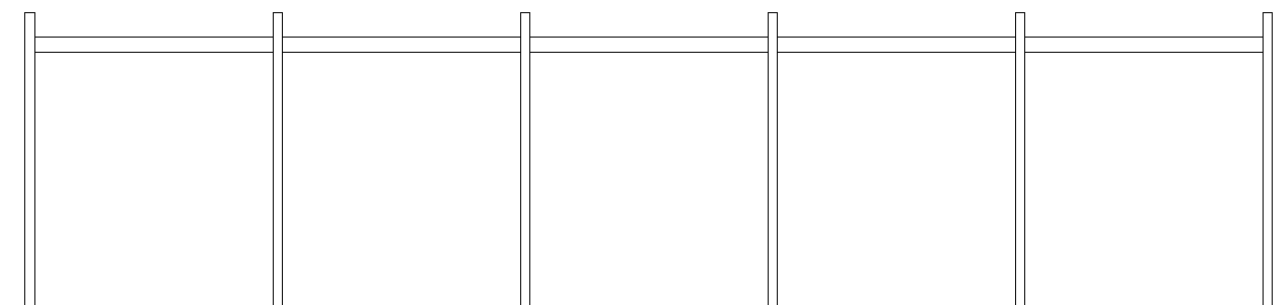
Estructura longitudinal rigidizada con trabe rígida en marcos continuos.
